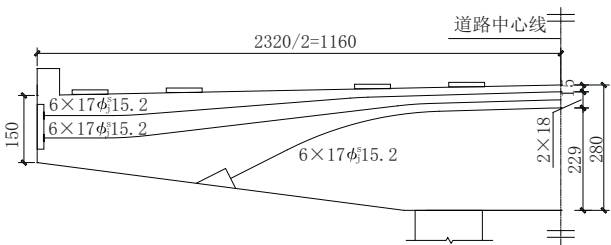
现浇预应力混凝土盖梁立面图(单位:cm)
